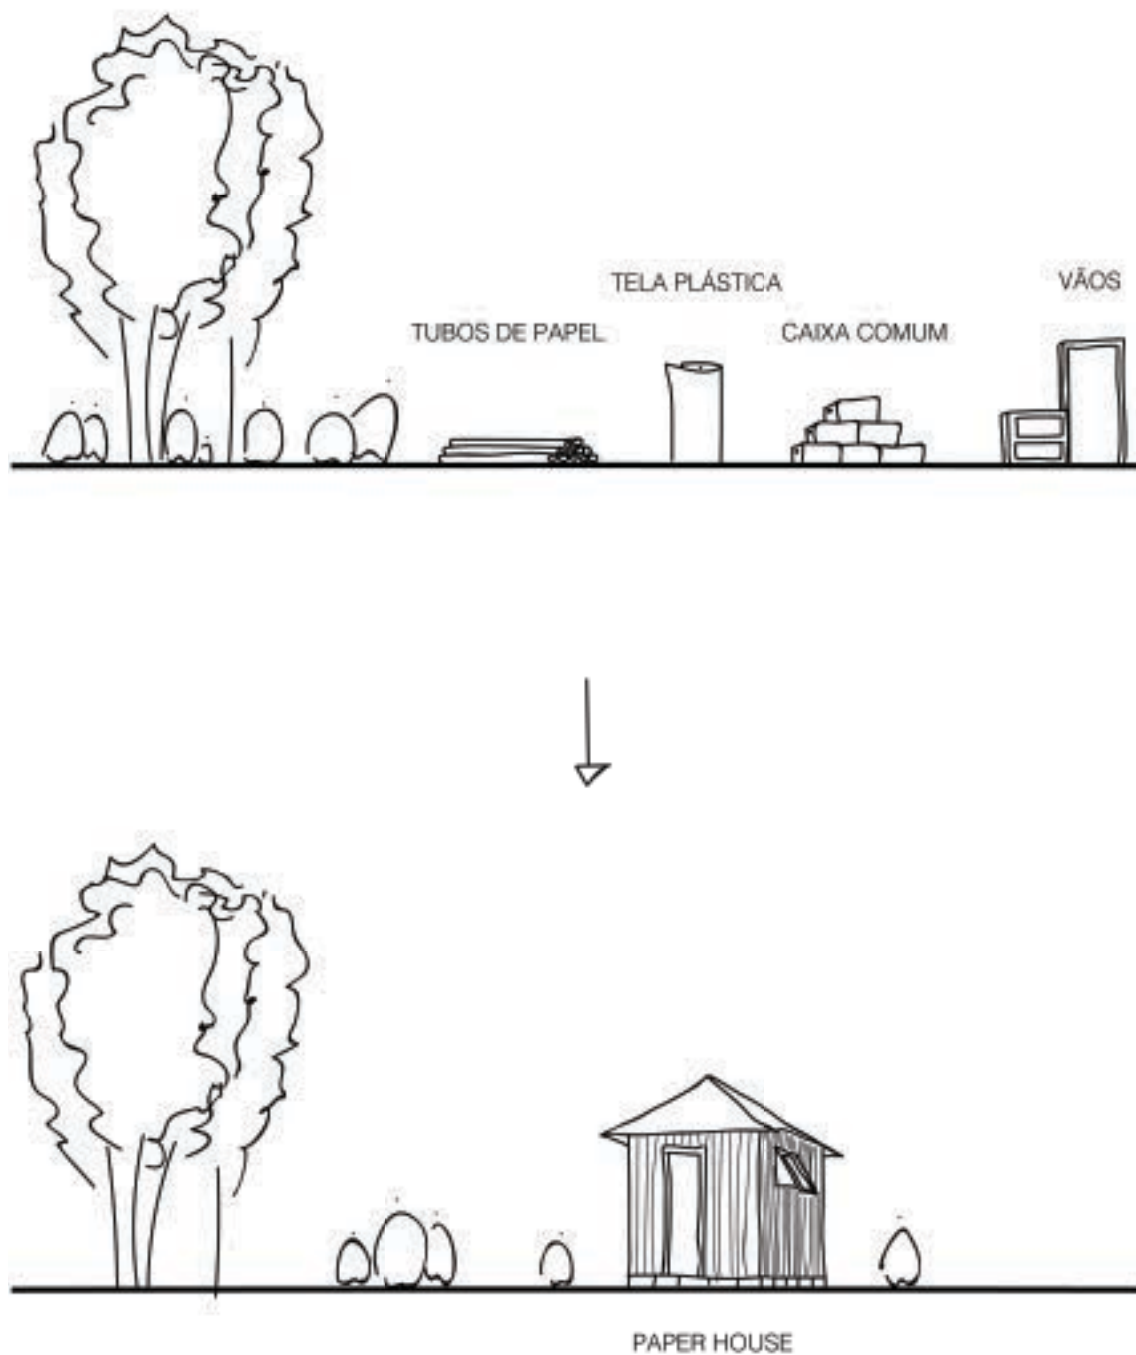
Processo construtivo do módulo Paper House. (Ilustração nossa, 2016).
